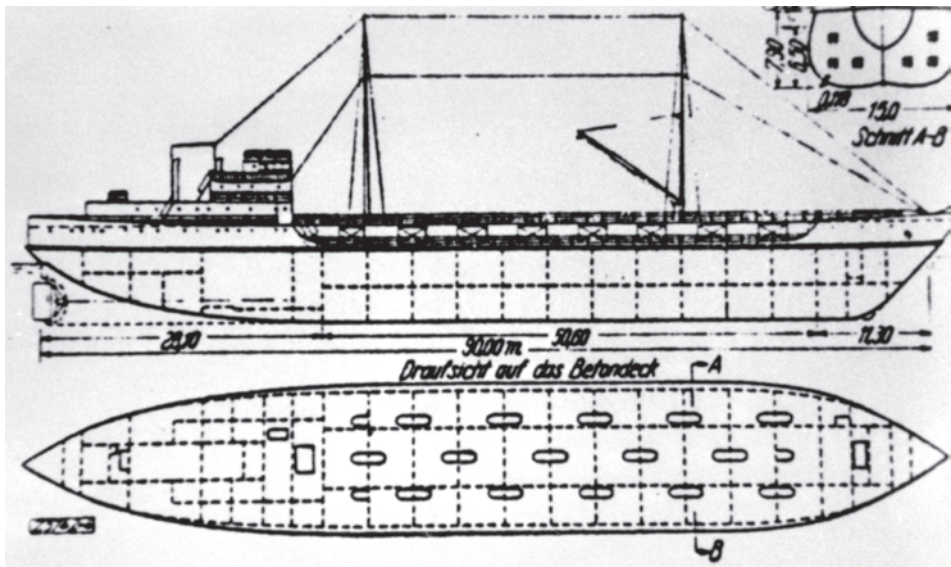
Seitenansicht, Draufsicht auf das Hauptdeck sowie Hauptquerschnitt eines Schwerbetontankschiffes in Schalenbauweise, wie es in Rügenwalde gebaut wurde. (Finsterwalder, Betonschiffe, S. 4)
